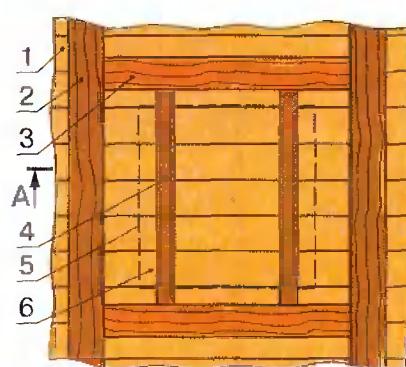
Конструкция съемного люка на чердак: 1 — обшивка потолка; 2 — балка перекрытия; 3 — ригель; 4 — бруски-стяжки; 5 — линия пропила; 6 — щит; 7 — рейка-фиксатор; 8 — наличник
